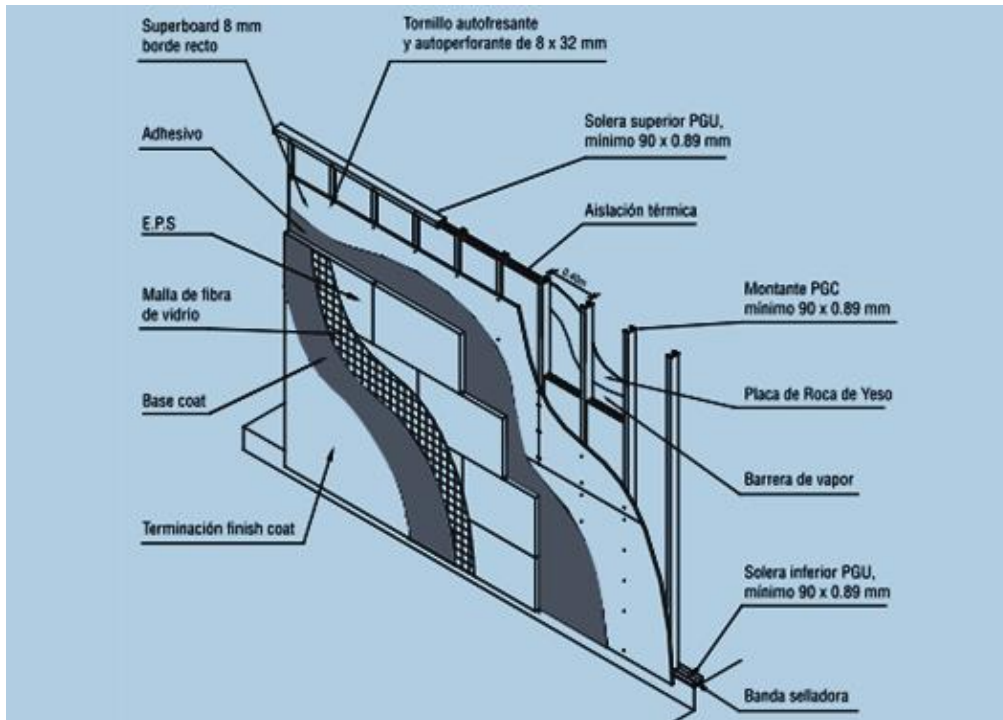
Detalle de muros exteriores. Fuente: <http://www.knauf.cl>.
